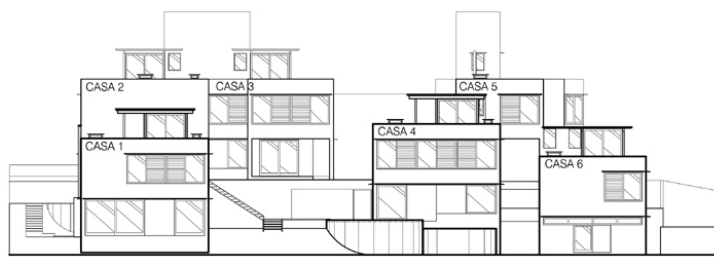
Fachada lateral da Vila Fidalga (H-03).
